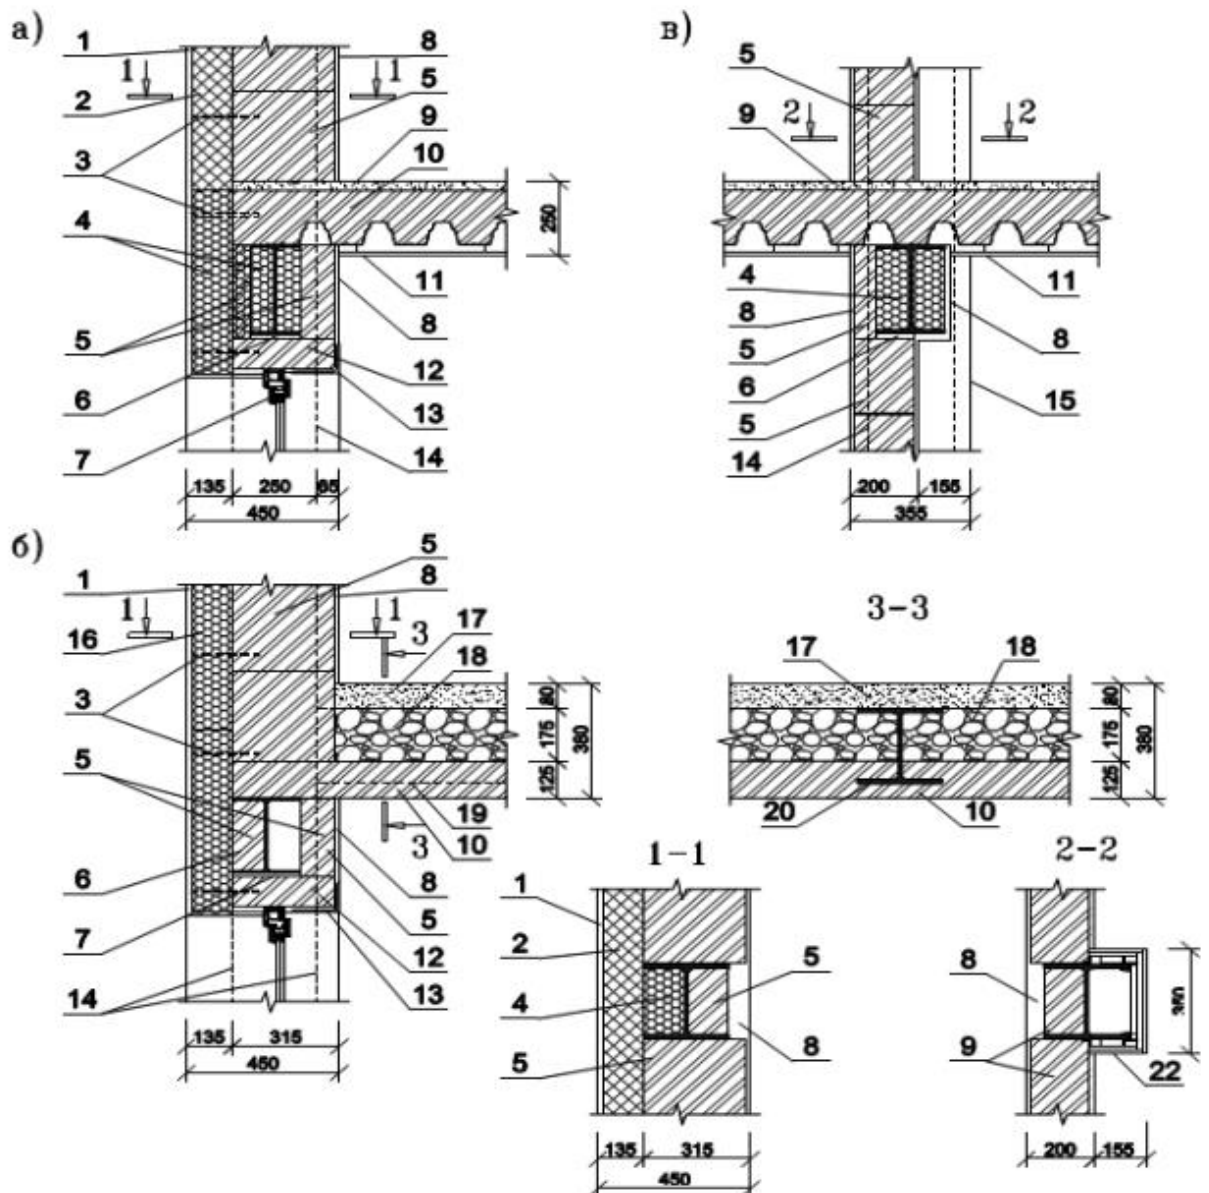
Пример огнезащиты двутавровой балки перекрытия
